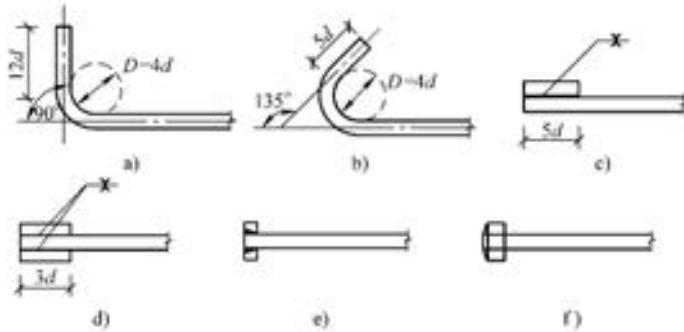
钢筋弯钩和机械锚固的形式和技术要求
